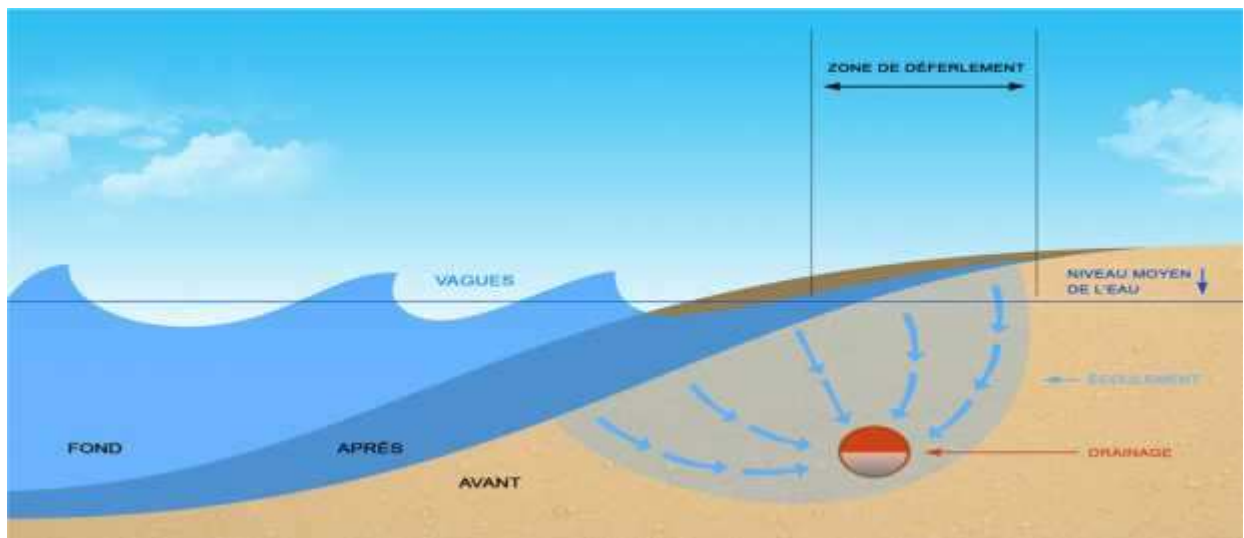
Schéma de principe d'un drainage de plage (ECOPLAGE)
